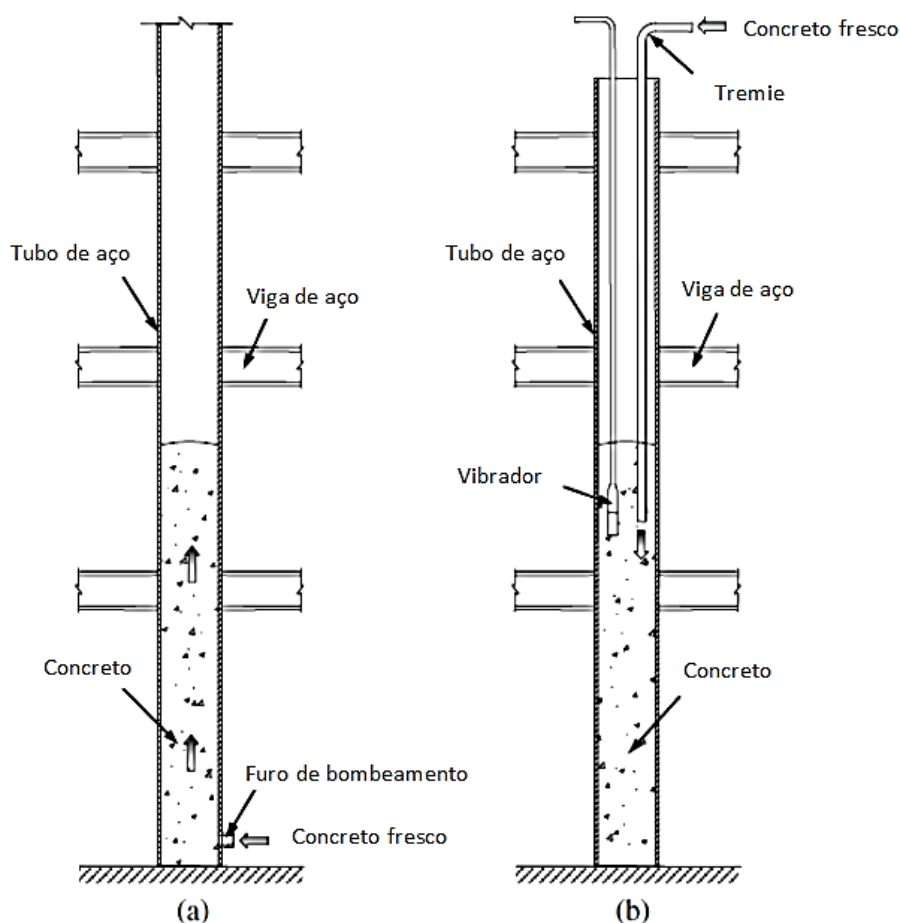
Vista esquemática da concretagem dos tubos de aço. (adaptado de HAN *et al.*, 2014)
